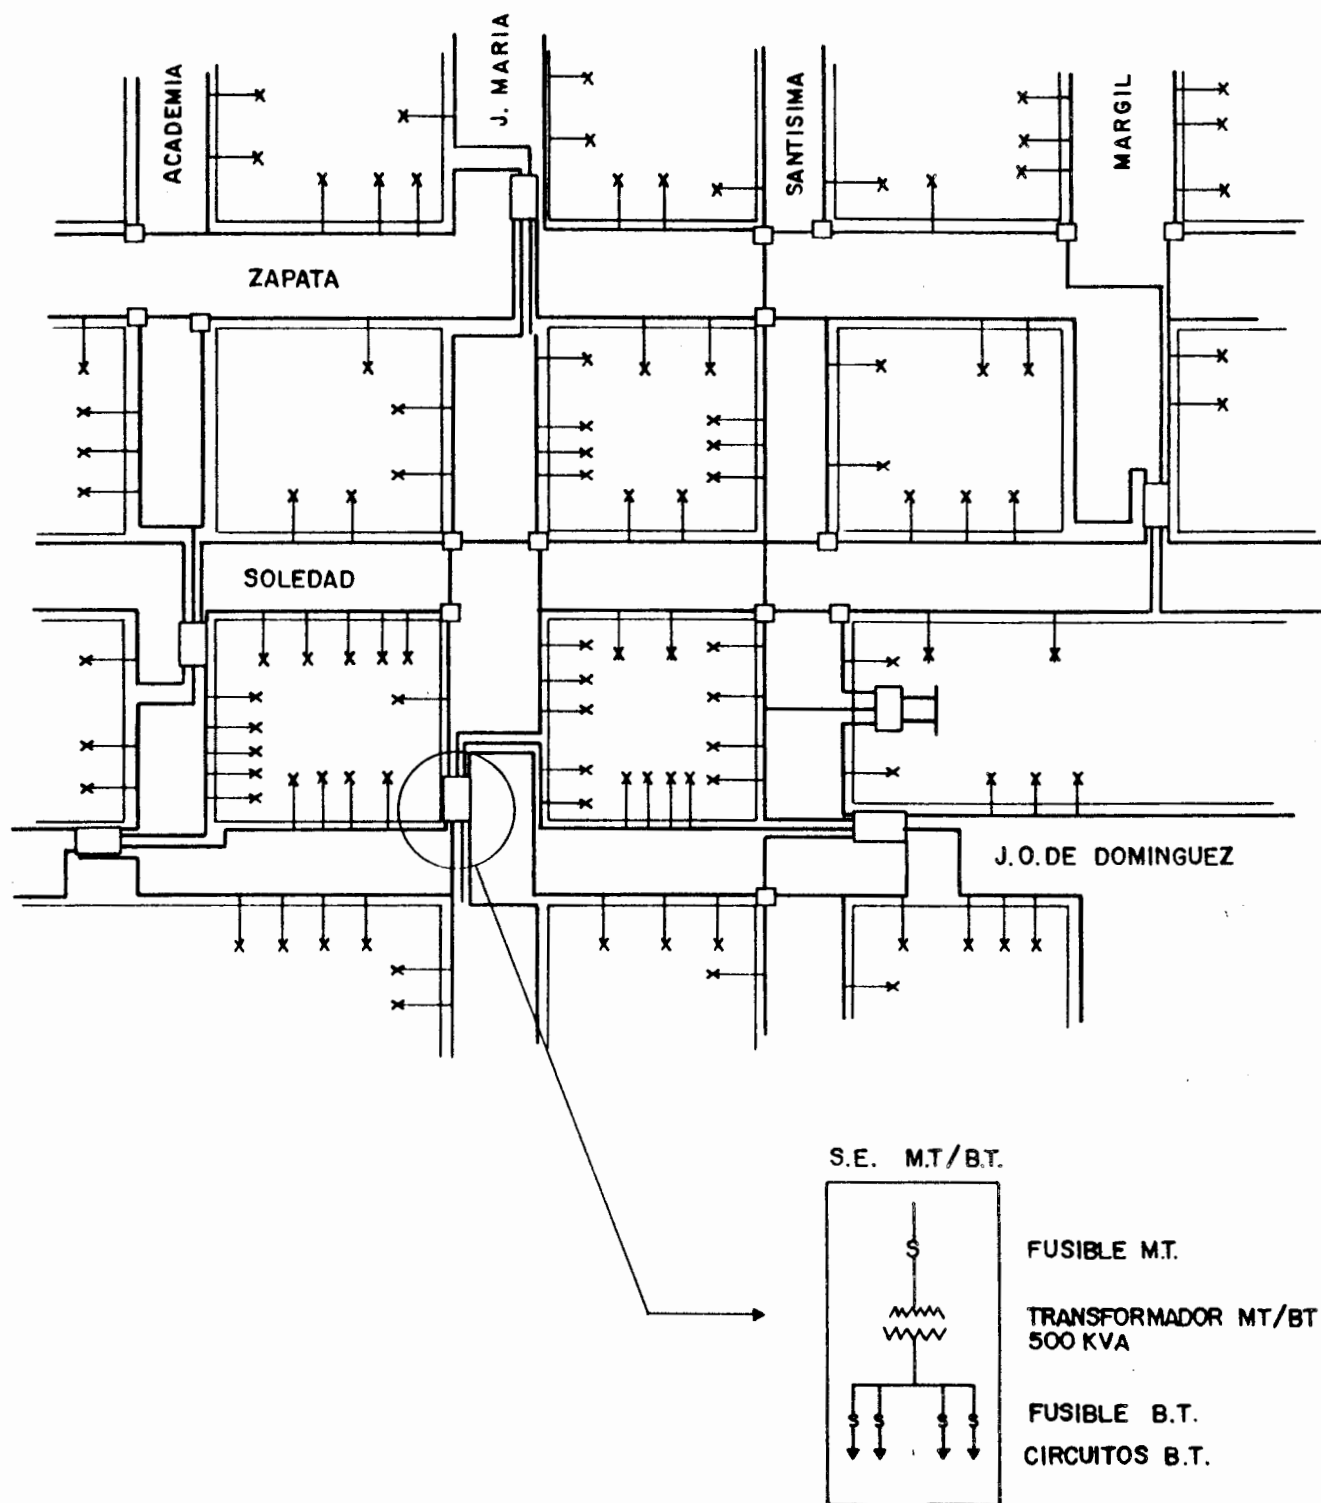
ESTRUCTURA DE BAJA TENSION CON SECCIONAMIENTO
